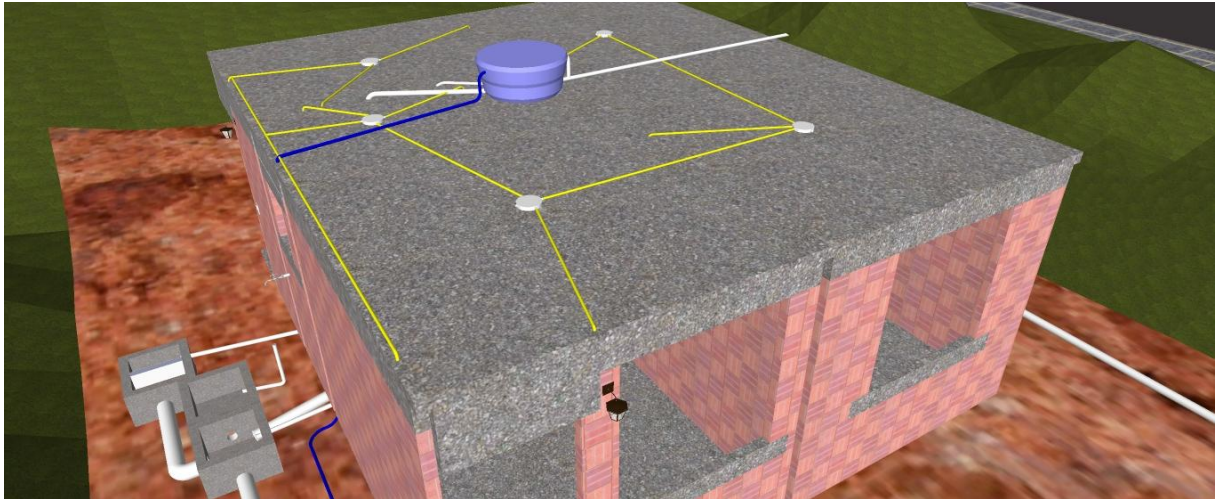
Ligações Prediais de Água, Esgoto e Elétrica – vista 3.
